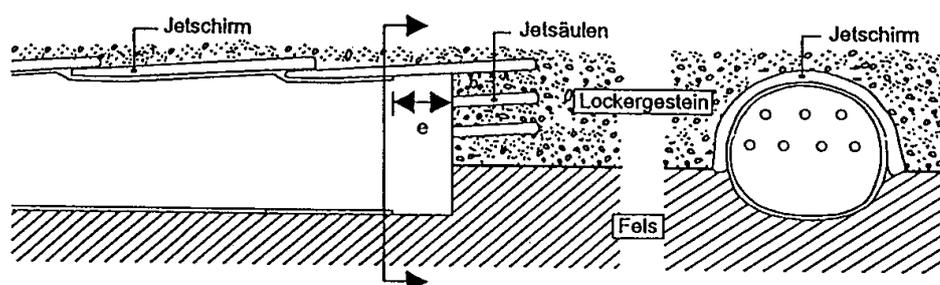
Vorseilendes Jetgewölbe im Tunnelbau
